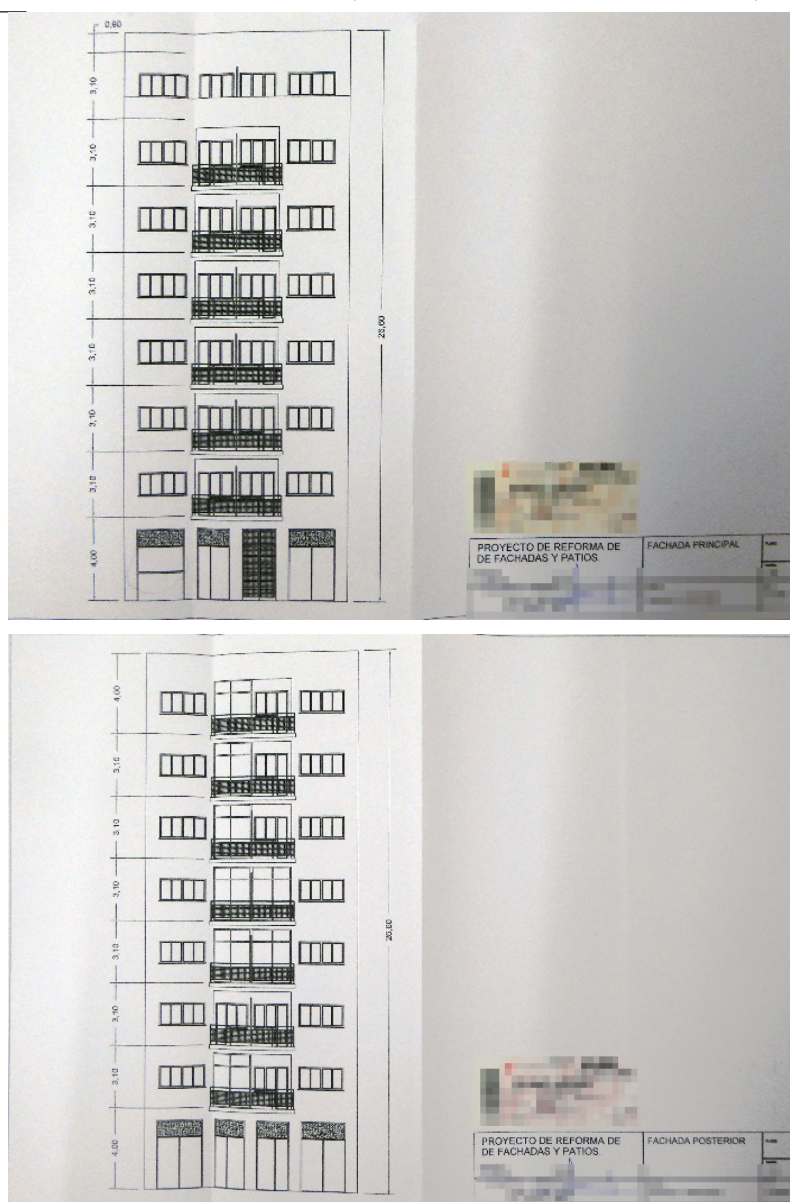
Planos fachada principal (dcha.) y fachada posterior (izq.) del estado previo del edificio. Nótese cerramientos existentes en las fachadas posteriores. De Ángel Castrel, Daniel. Planos 2 y 3. Expediente 02.2007L02734. Arxiu Municipal del Eixample
